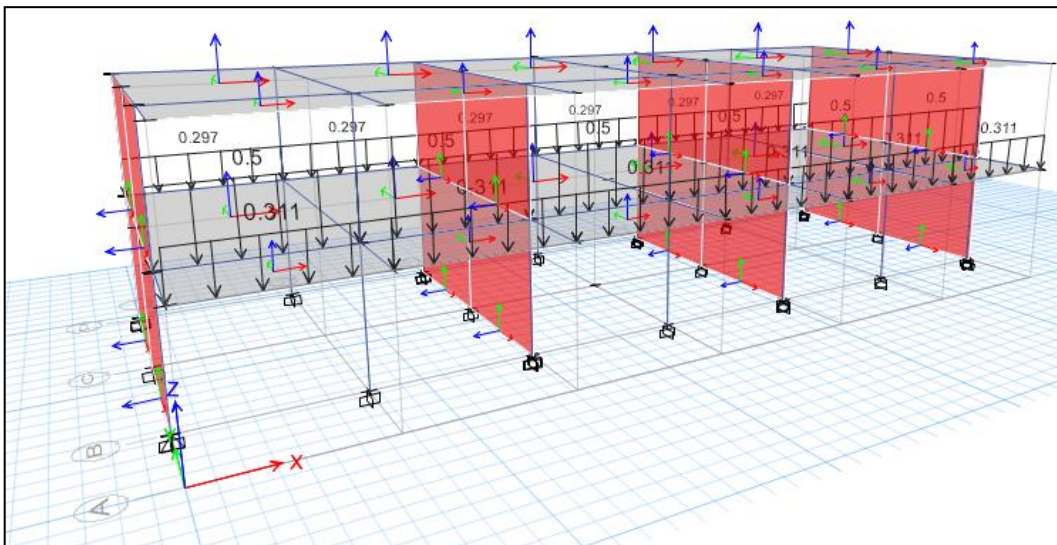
Cargas distribuidas de parapetos y tabiquería en eje B y D del pabellón 2
